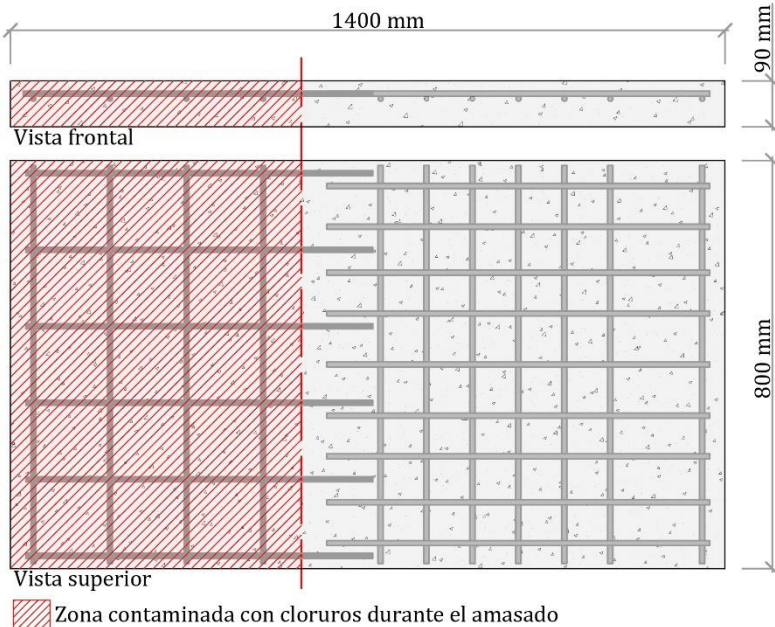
27- Geometría de la losa de hormigón armado fabricada. Elaboración propia.
